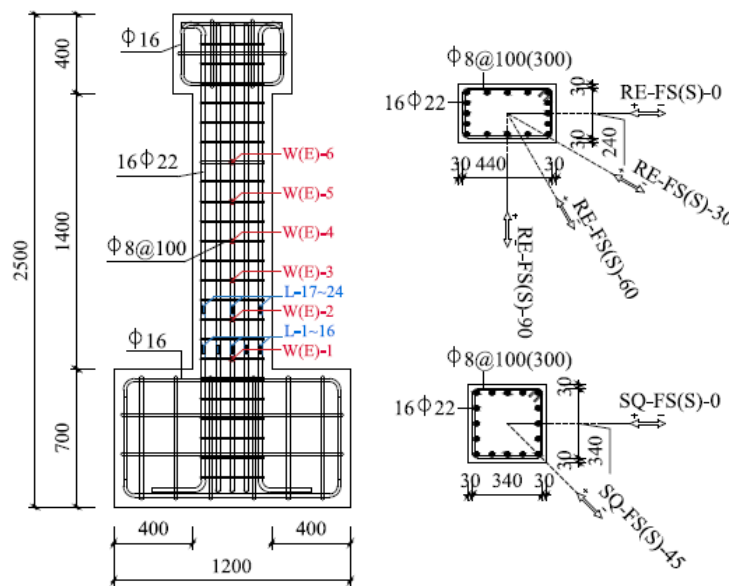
Layout generale (misura in [mm]) e disposizione dell'armatura delle colonne in calcestruzzo armato (CA) testate: passo delle staffe pari a 100 mm).
